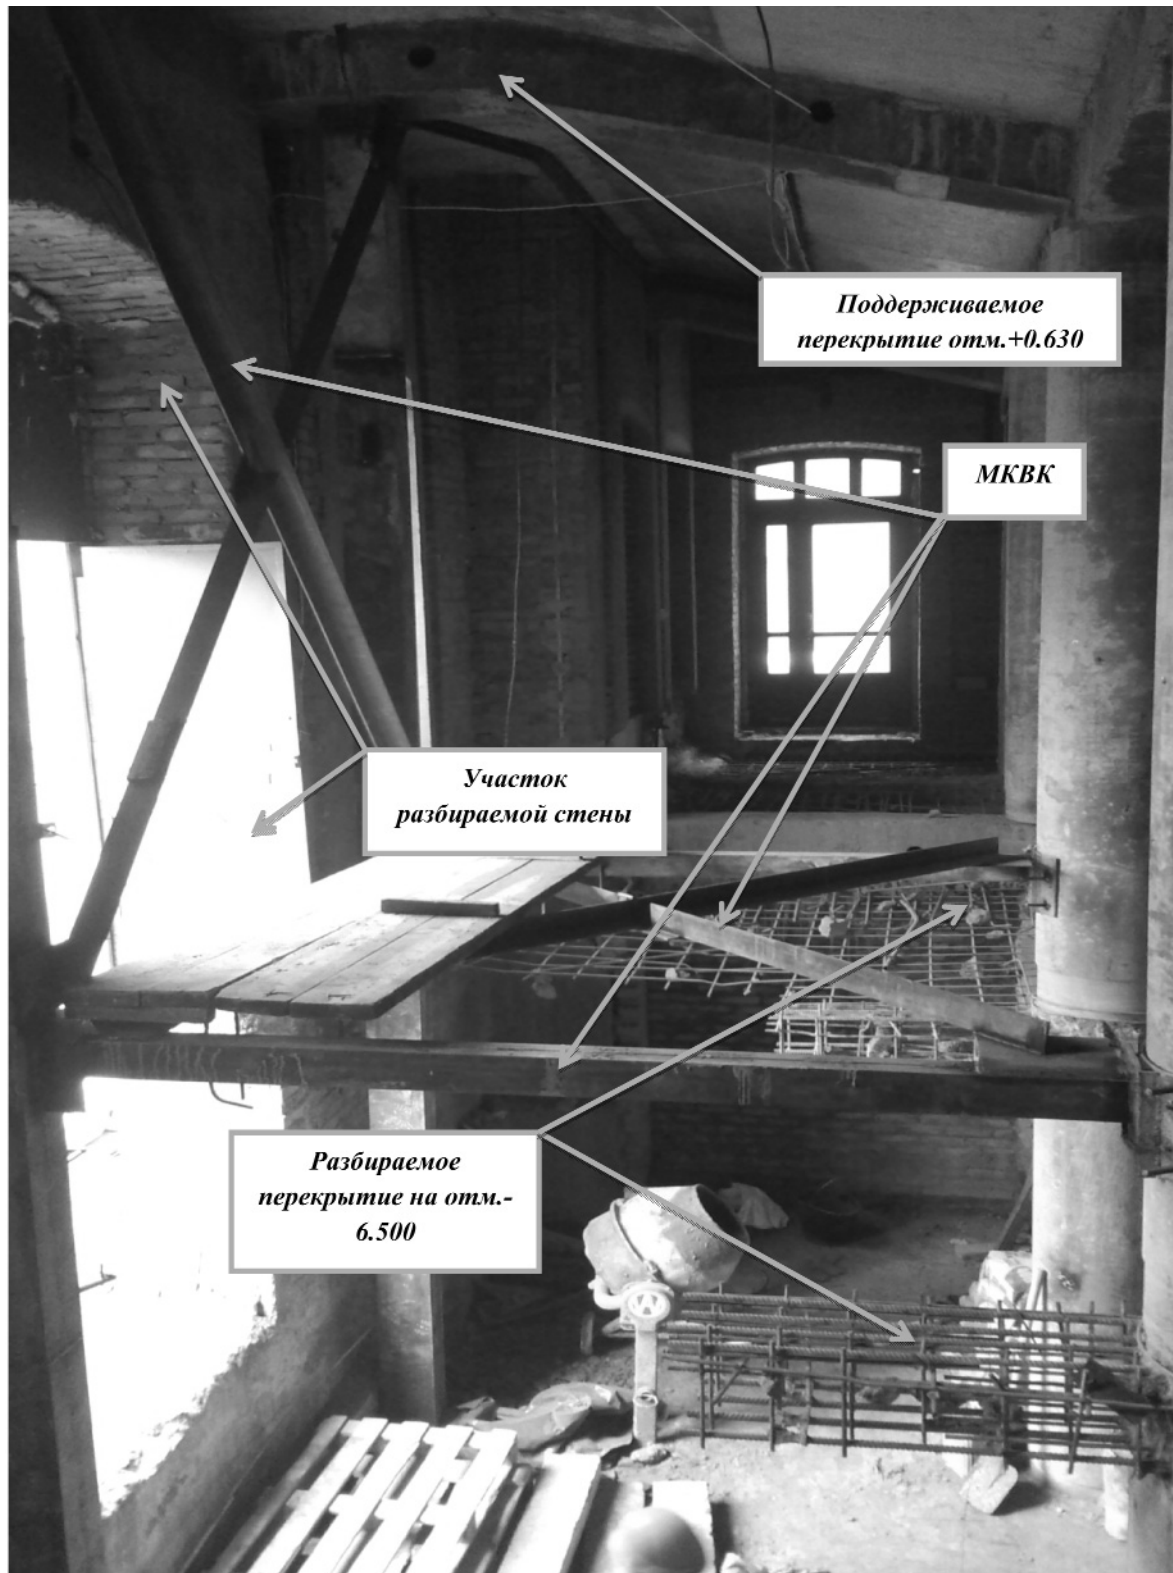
Устройство металлической конструкции временного крепления (МКВК) плиты перекрытия
